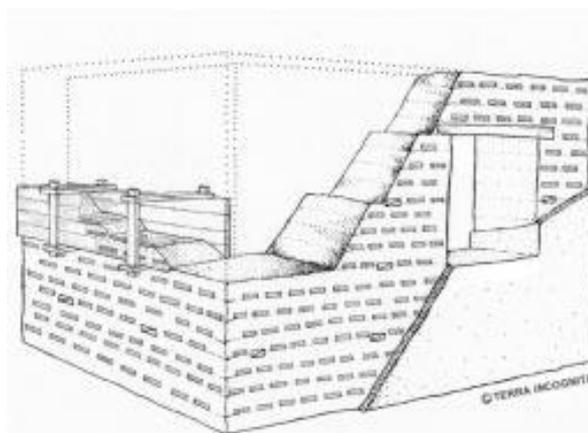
Detalle de Muro de tapia valenciana. Fuente: Restapia.
